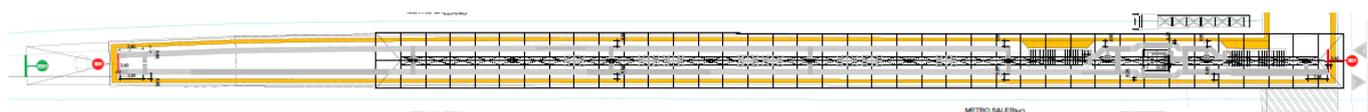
Percorso privo di ostacoli, pianta piano banchine
